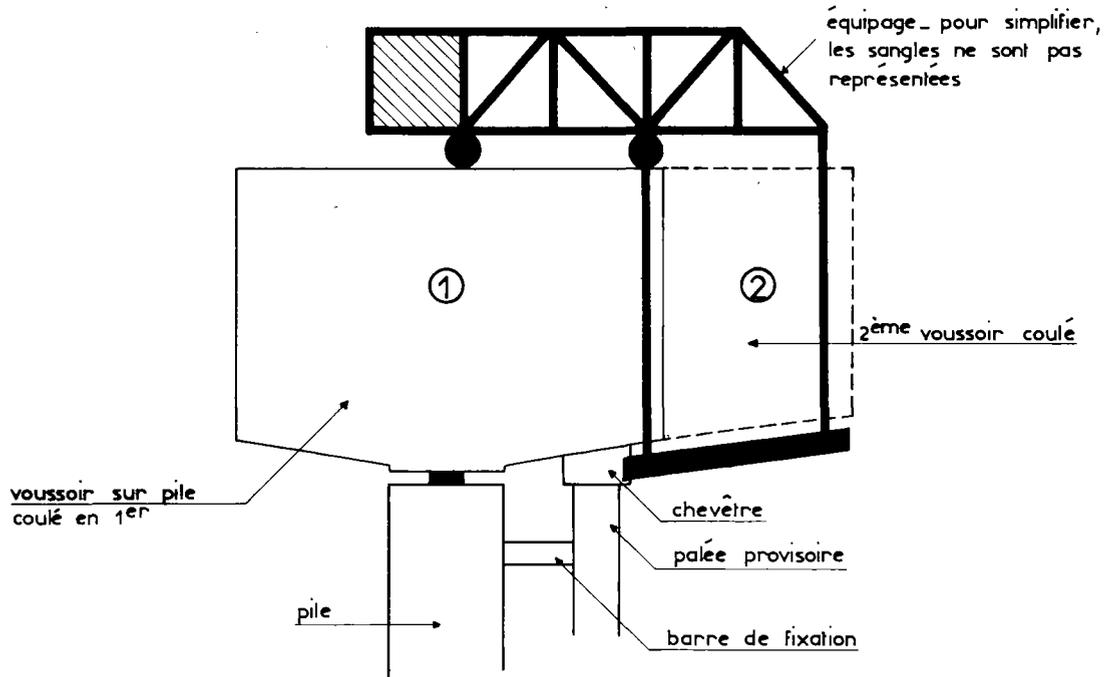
a. Construction du voussoir n° 2 après mise en place du premier équipement.
